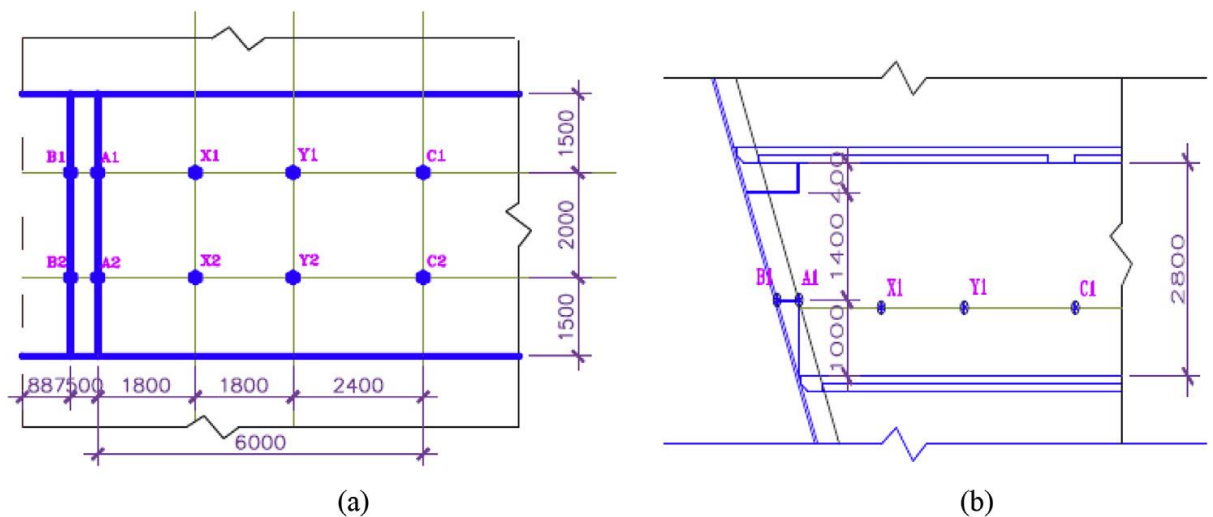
Vue en plan (a) et coupe verticale (b) du bureau montrant la position des appareils de mesure.
